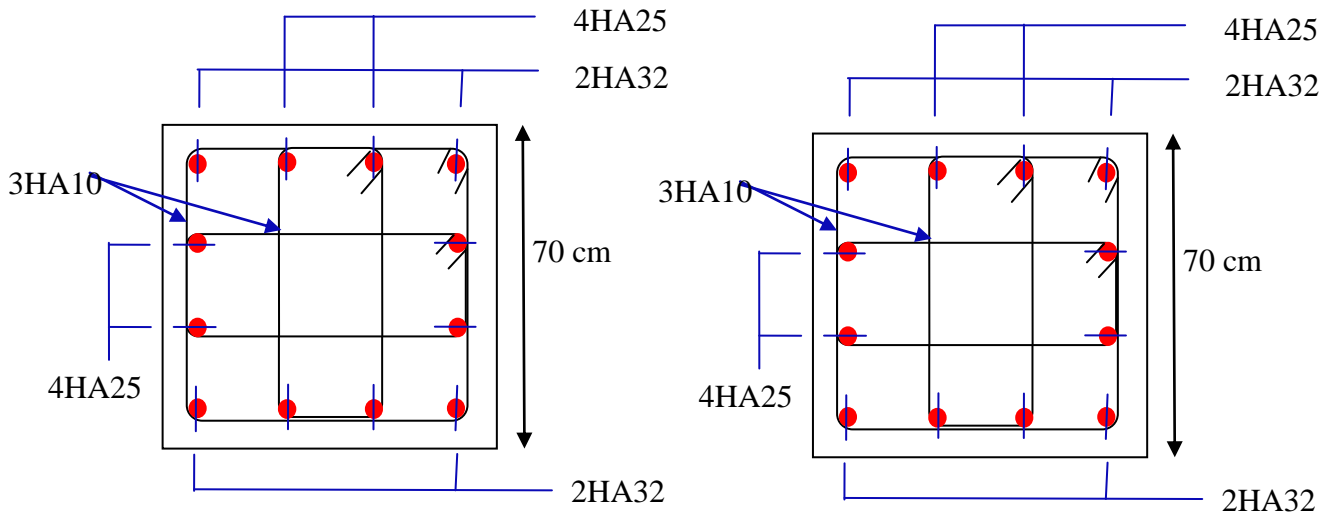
Schémas de ferrailage des poteaux isolés et attachés aux voiles
